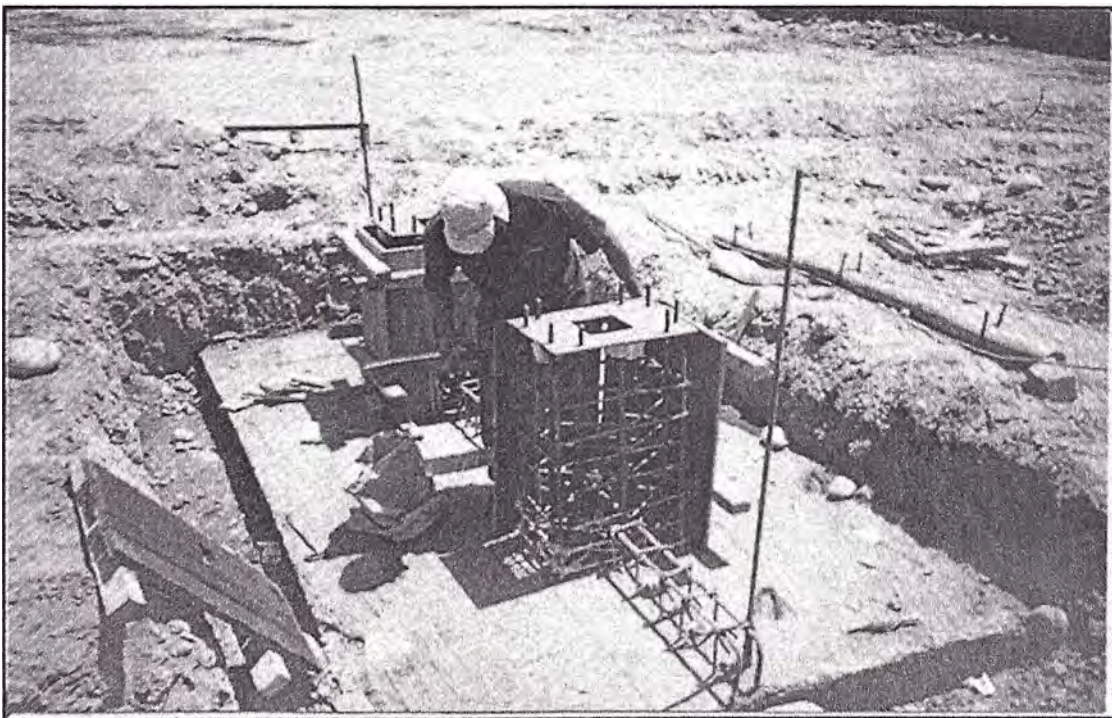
Colocado el anclaje a nivel se comienza a encofrar las columnetas del techo metálico.
